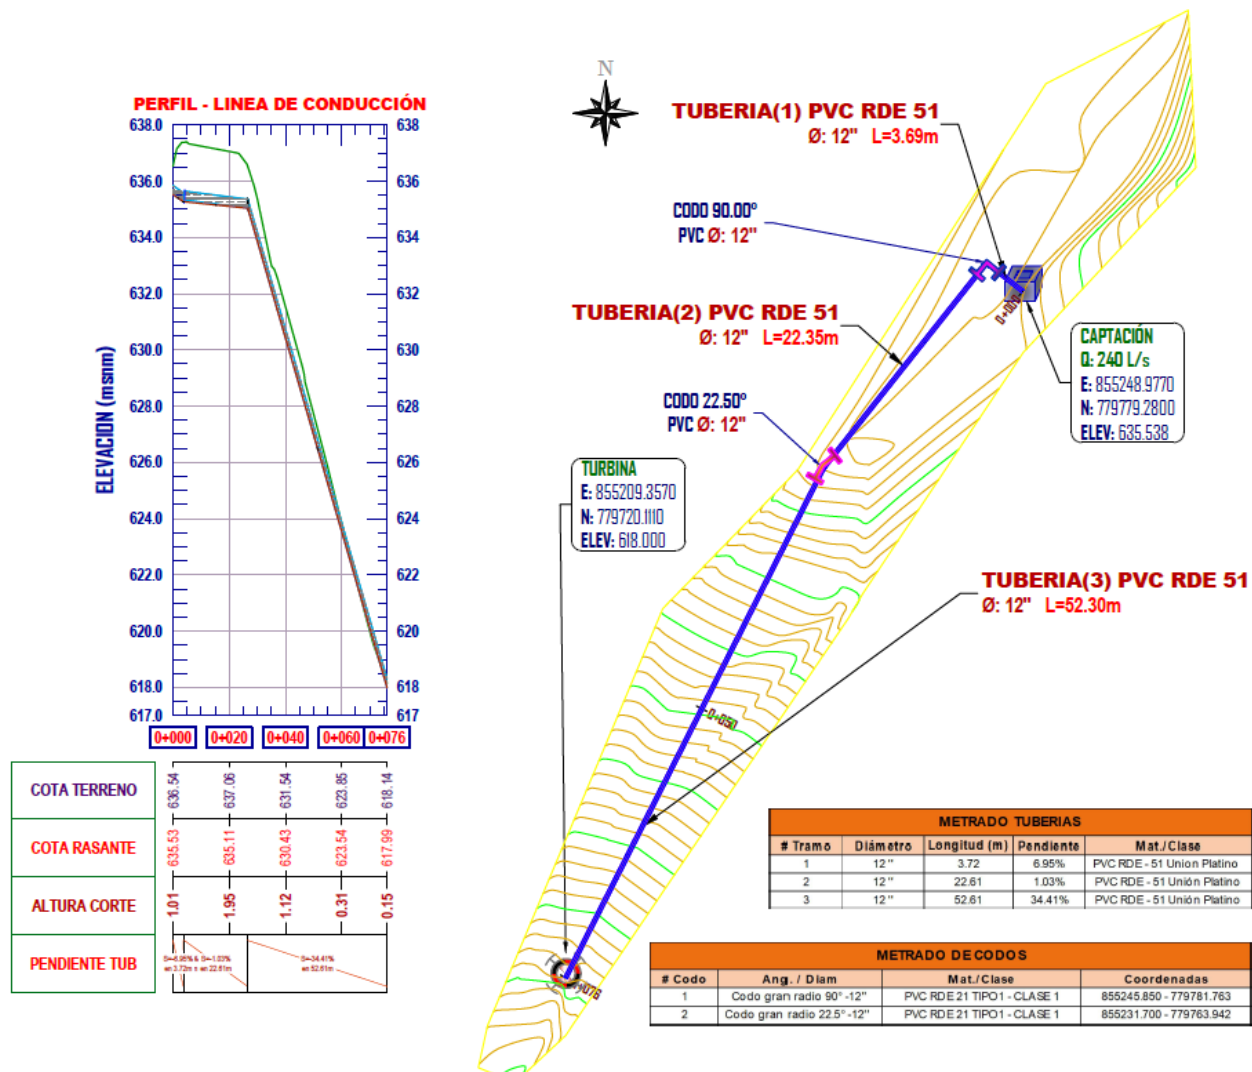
Guía de instalación de tubería línea de conducción: Plano 2.
